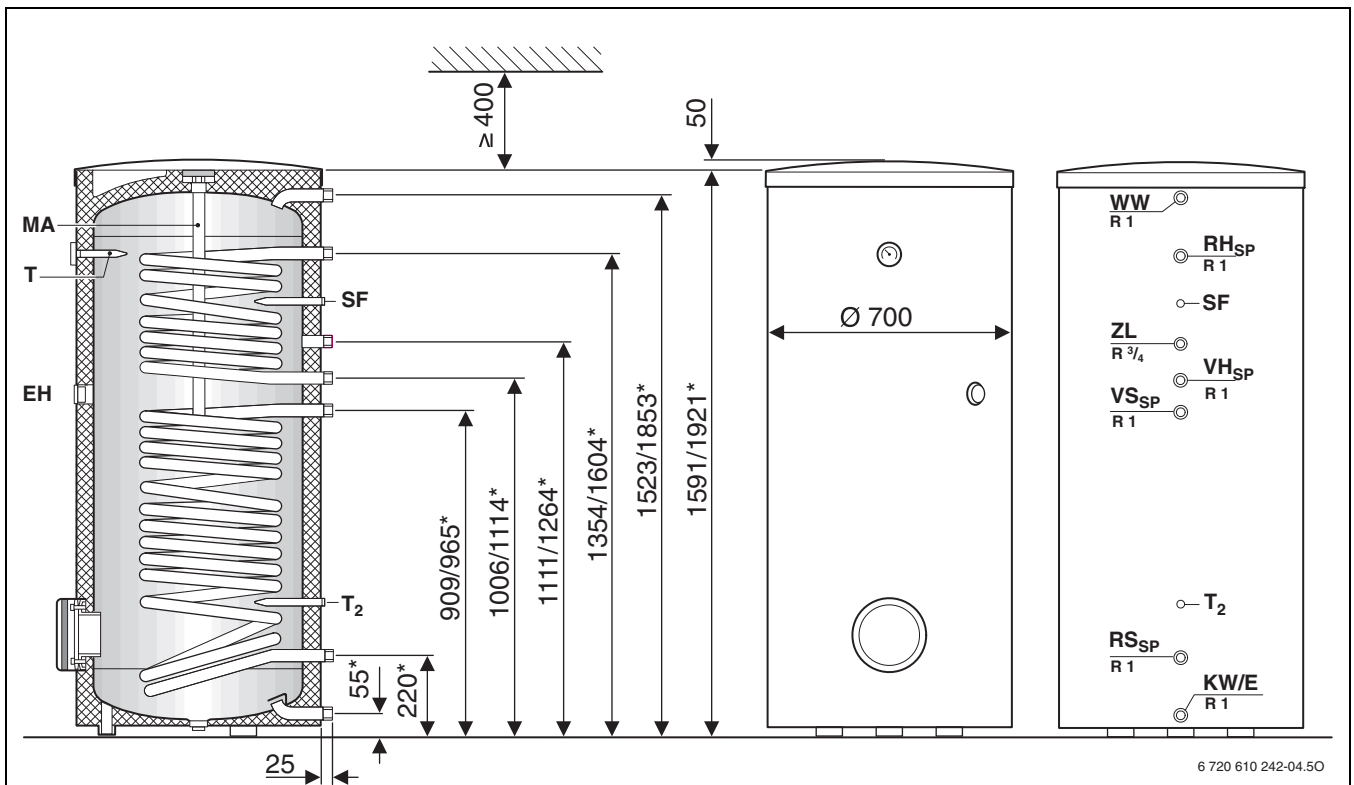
Габаритные и присоединительные размеры SK 400/500-1 solar
